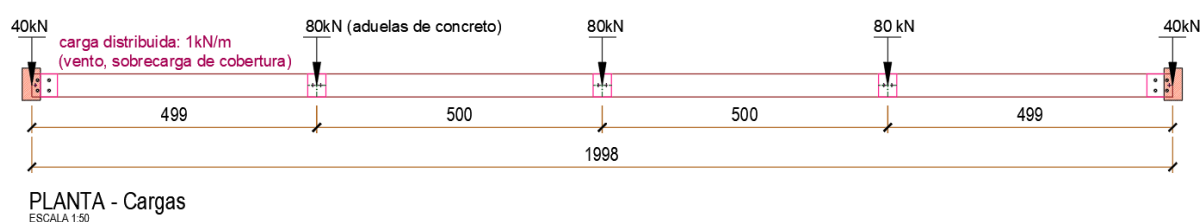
Cargas aplicadas nas vigas VPT01 e VNA02. (Autor, 2020)
